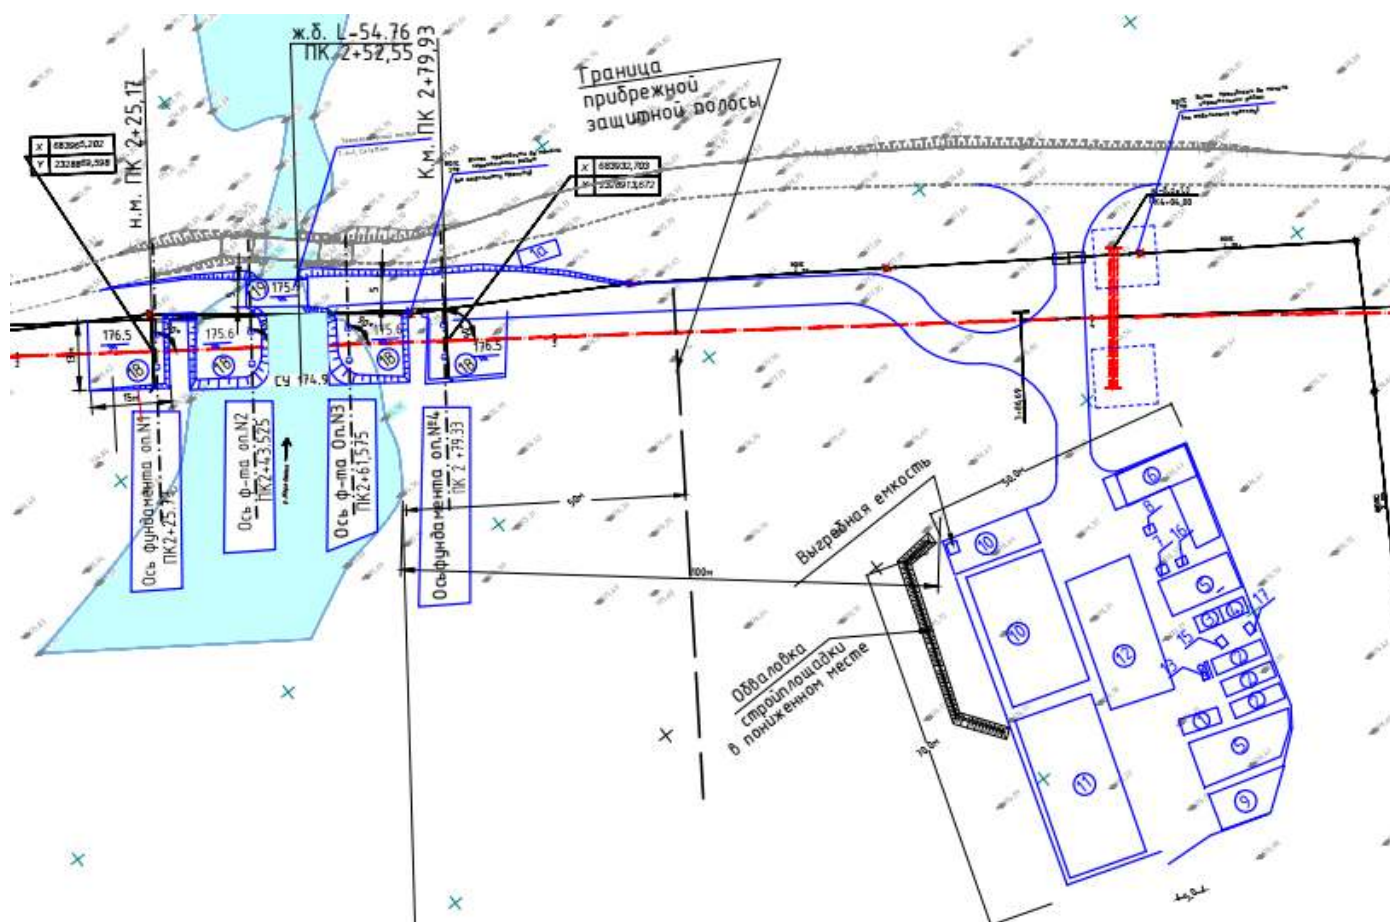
Схема размещения стройплощадки, рабочих площадок и проезда
